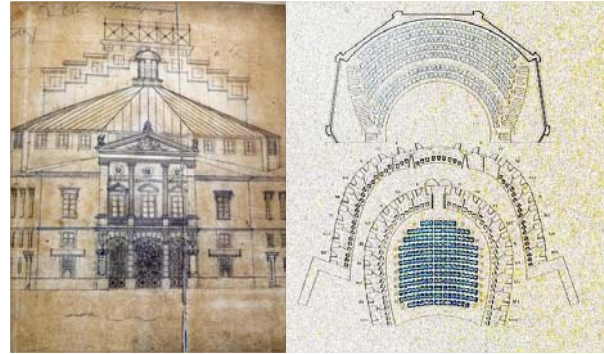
y 3. Croquis de la fachada principal del teatro con la caja de escena al fondo. Planta del patio de butacas y las plateas.
